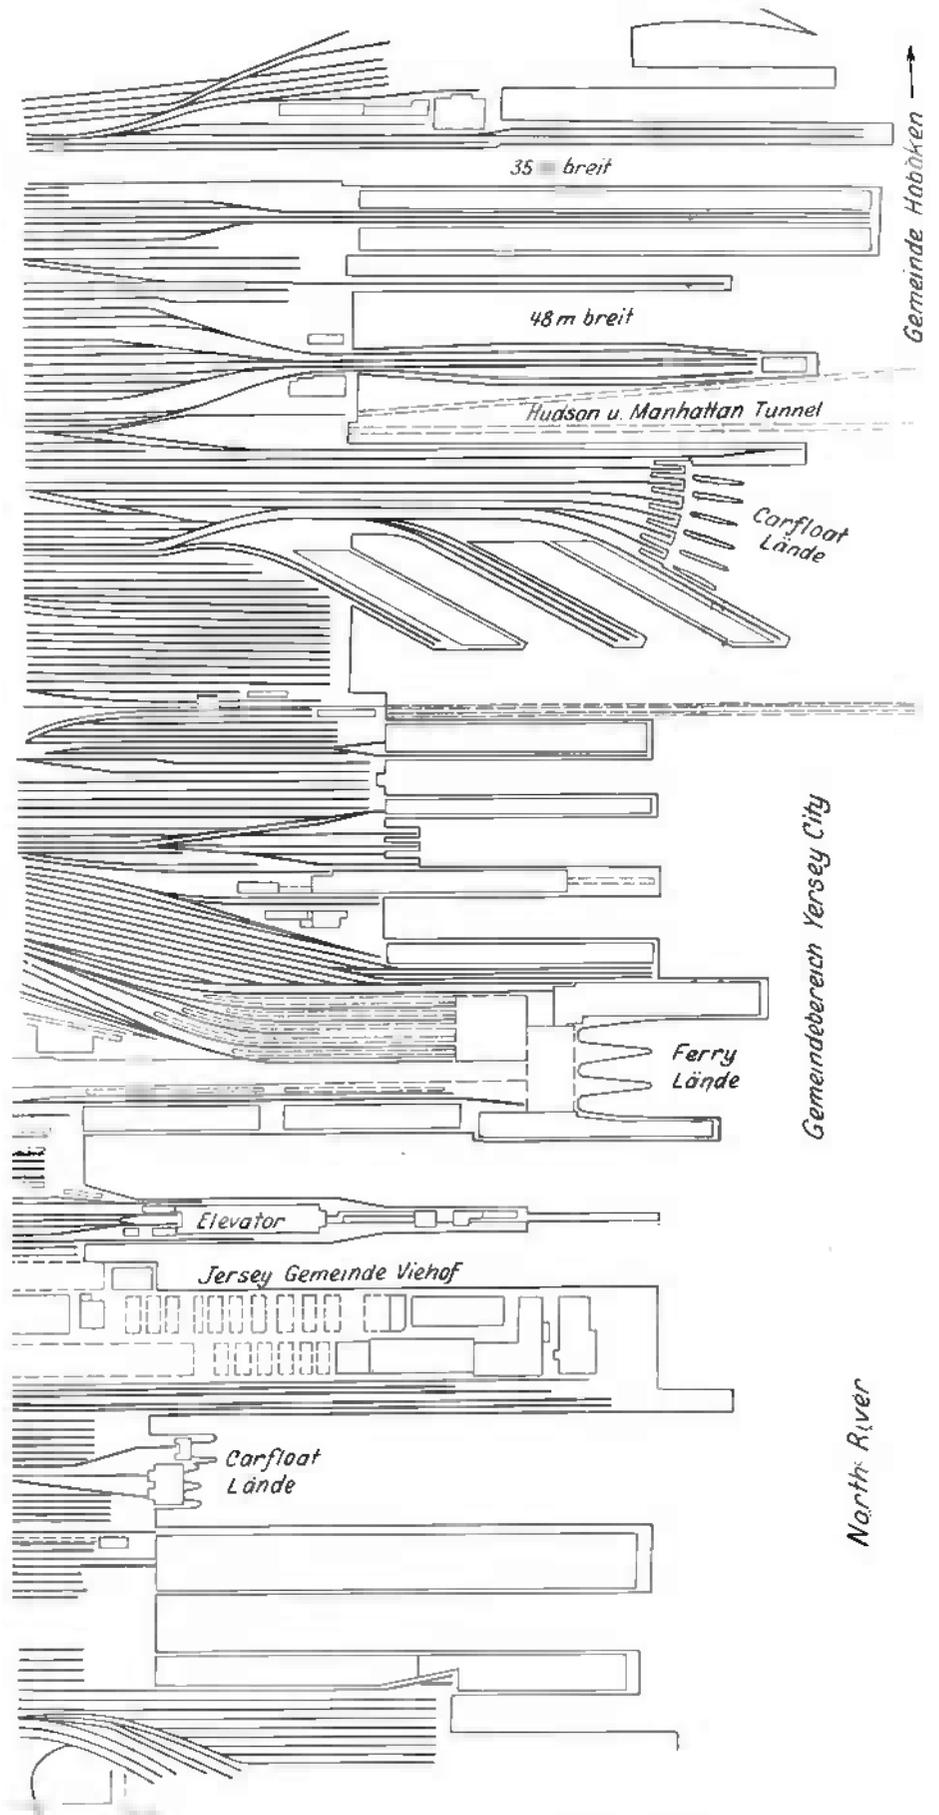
Gruppe von Piers, Ferry- und Carfloat-Länden mit Eisenbahnanschlüssen.
